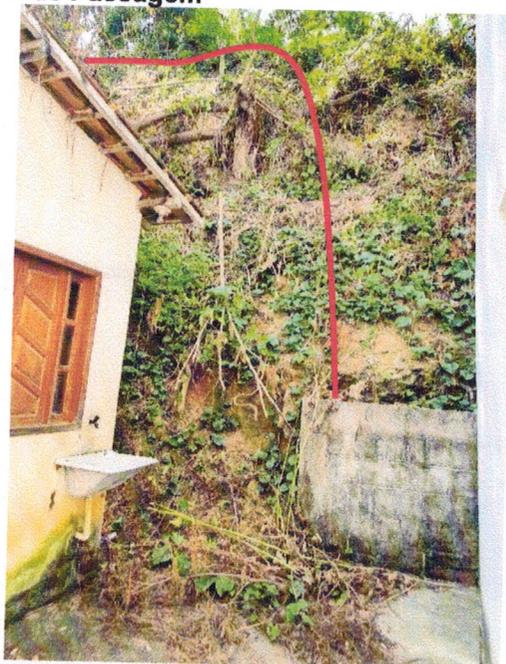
Detalhe do escorregamento que provocou o soterramento do imóvel do Conselho Tutelar
